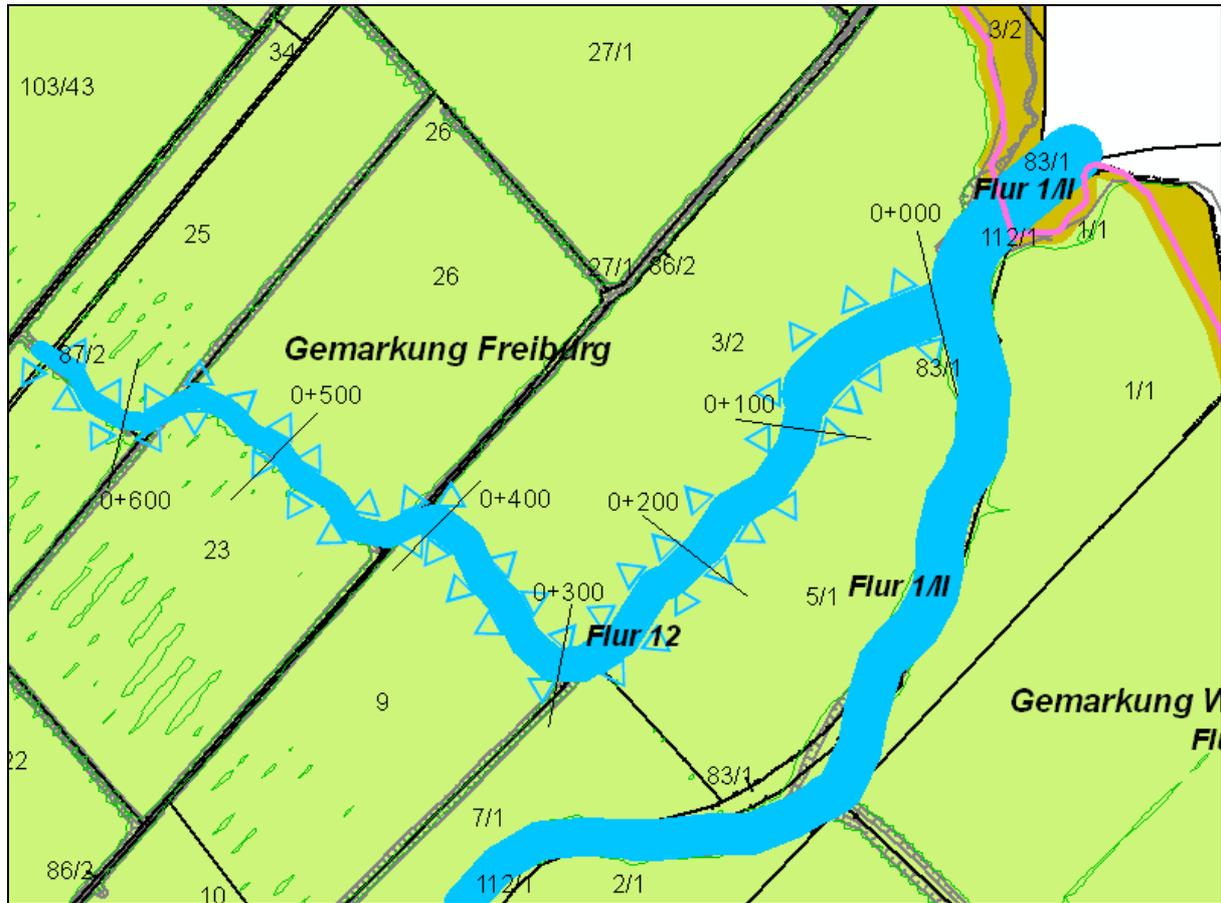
Lageplan des aufgeweiteten Priels mit Stationierung
